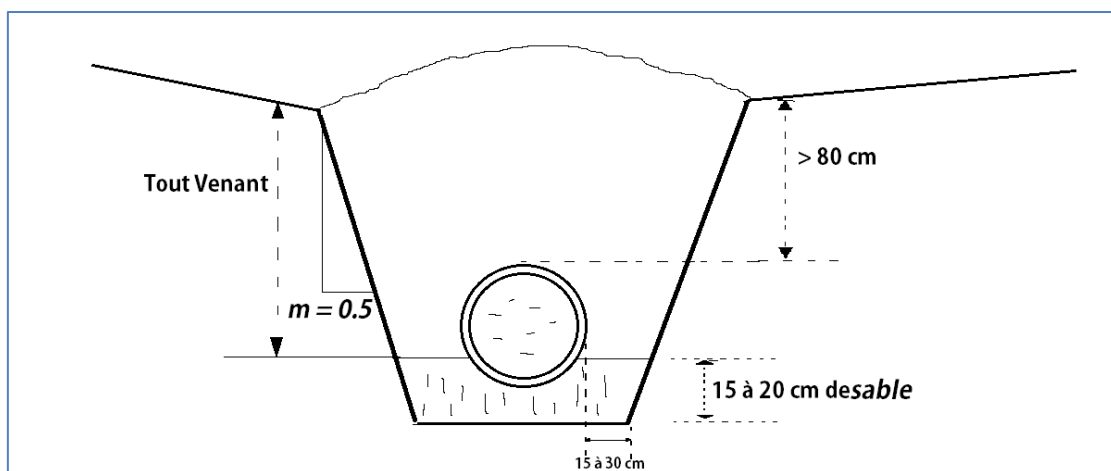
Pose de conduite en tranchée dans un terrain ordinaire.
